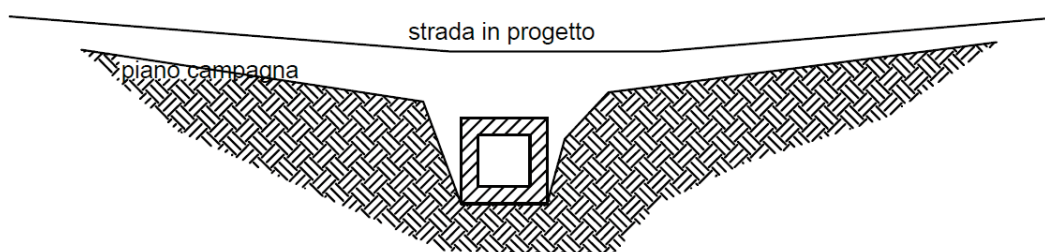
Indicazione della posizione dello scatolare rispetto alla strada in progetto - sezione trasversale
